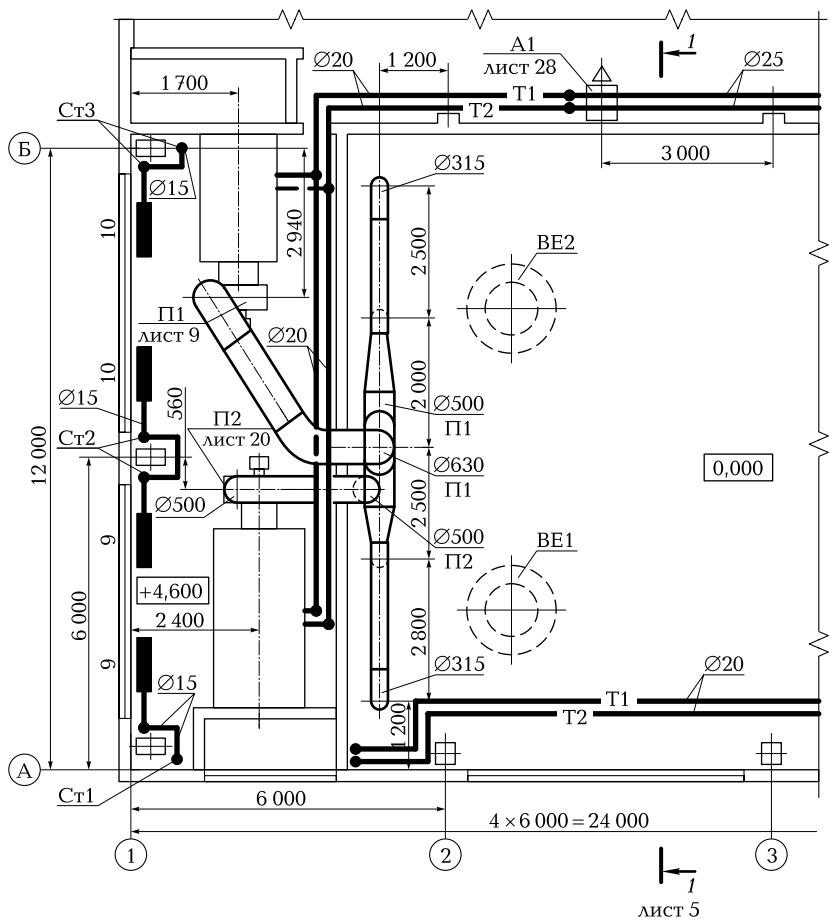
Чертеж части плана производственного здания с сетями отопления и вентиляции
